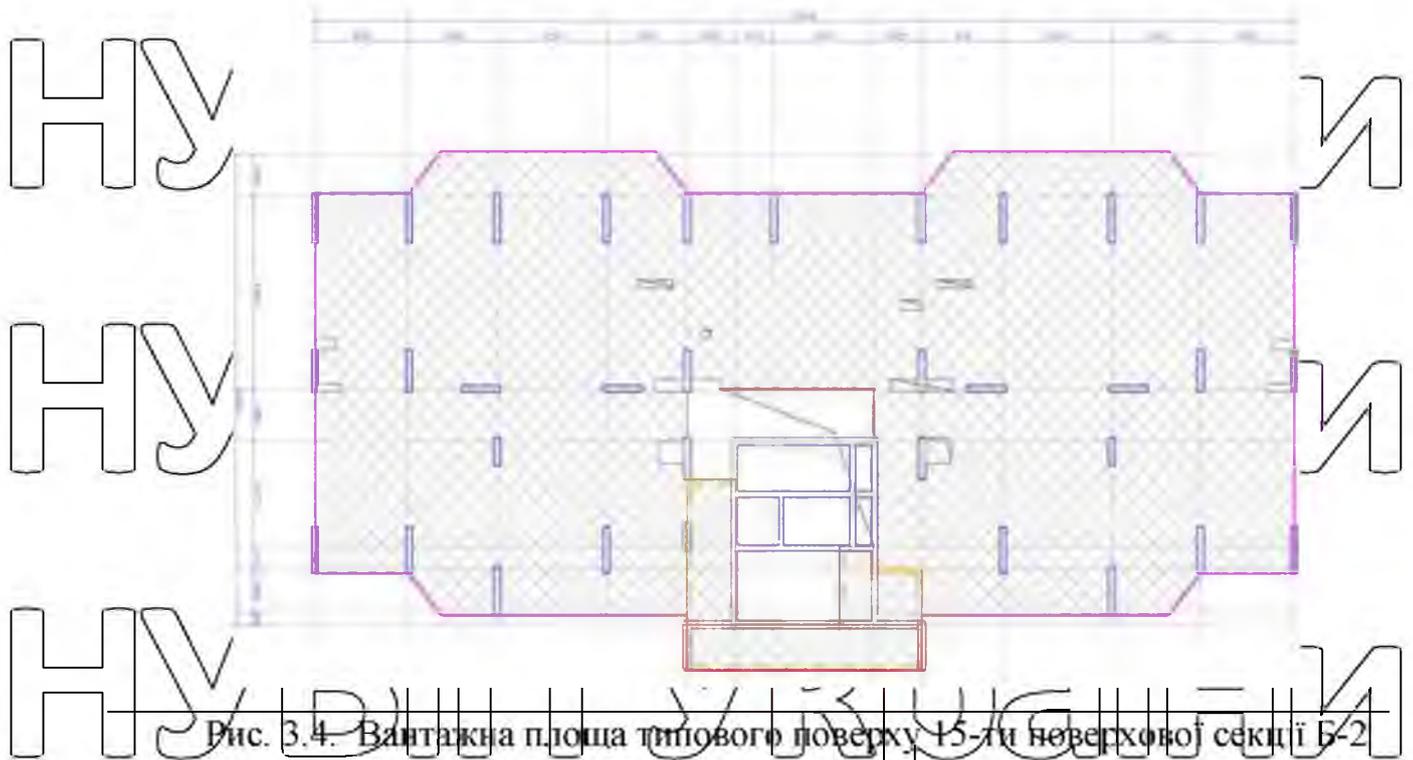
Вантажна площа типового поверху 15-ти поверхової секції Б-2
